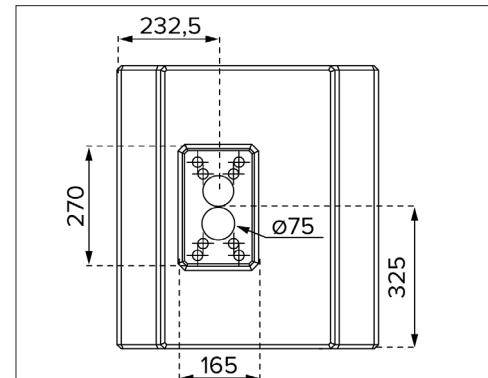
Maße Fertigfundament [mm] - Draufsicht
